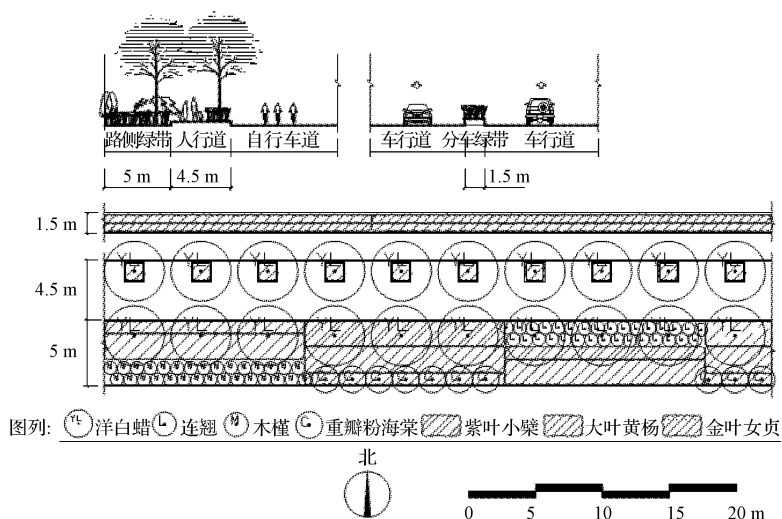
5 m 宽路侧绿带及 1.5 m 宽分车绿带植物配置平面断面图
